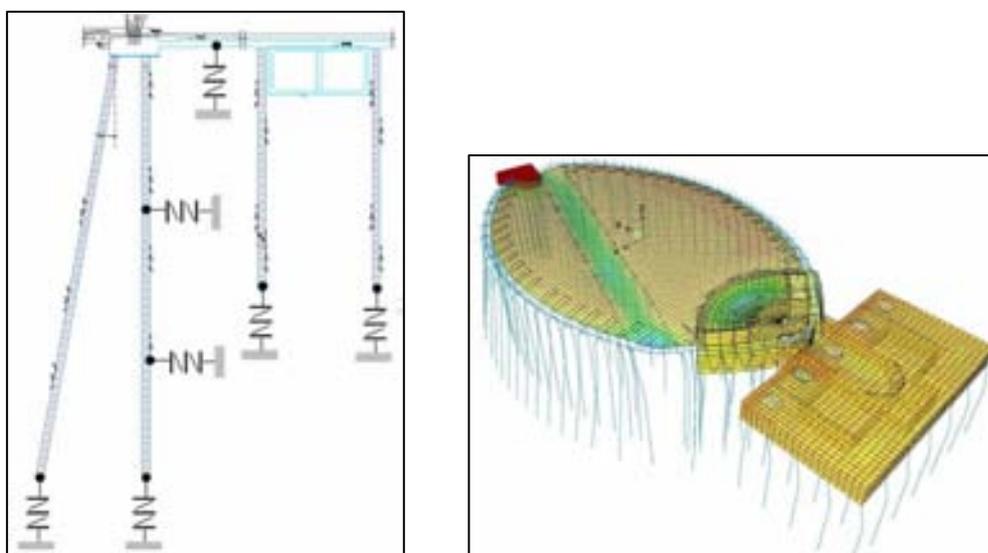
Esquema estático de la cimentación y modelo de cálculo
